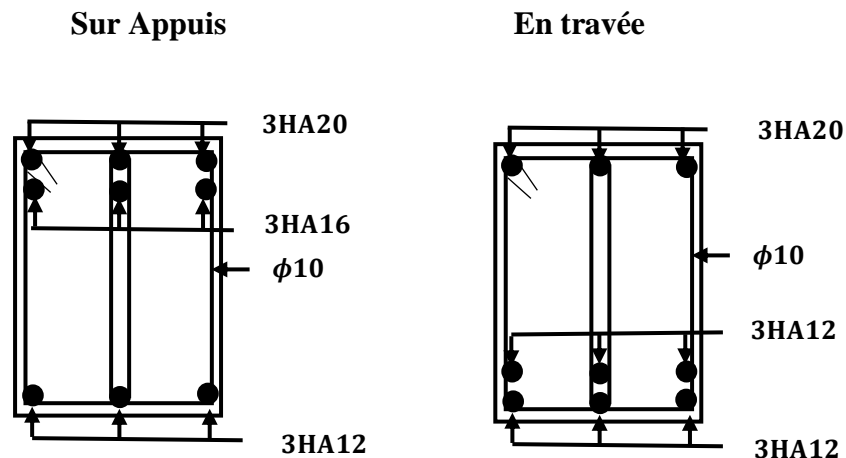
Schéma du ferrailage des poutres secondaires 30× 40
